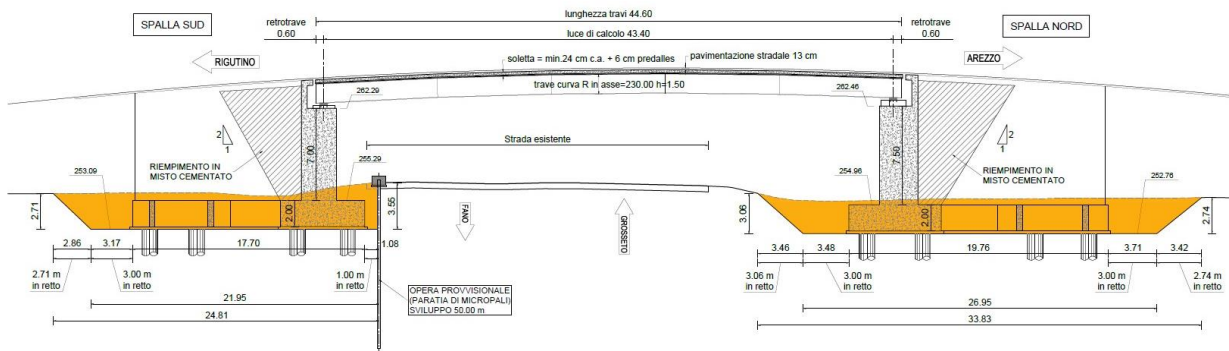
Sezione longitudinale Cavalcavia CV02
